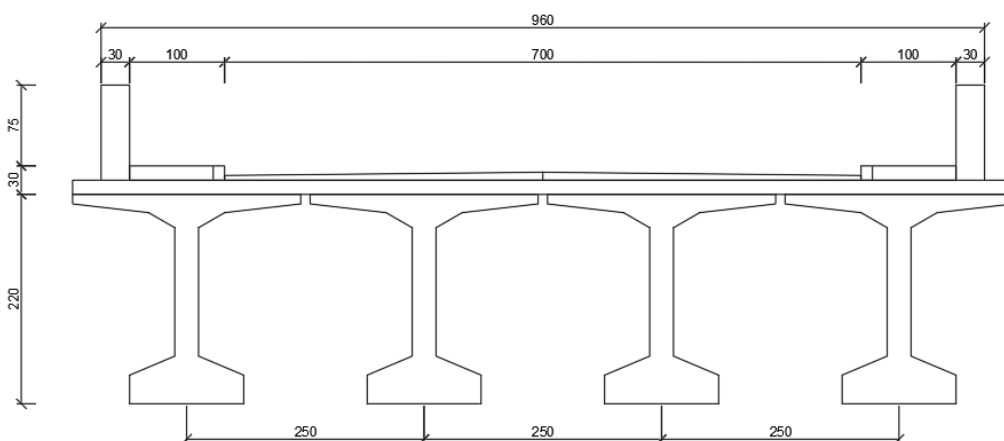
4 Tampak Samping Girder Jembatan Panjang 60 Meter
